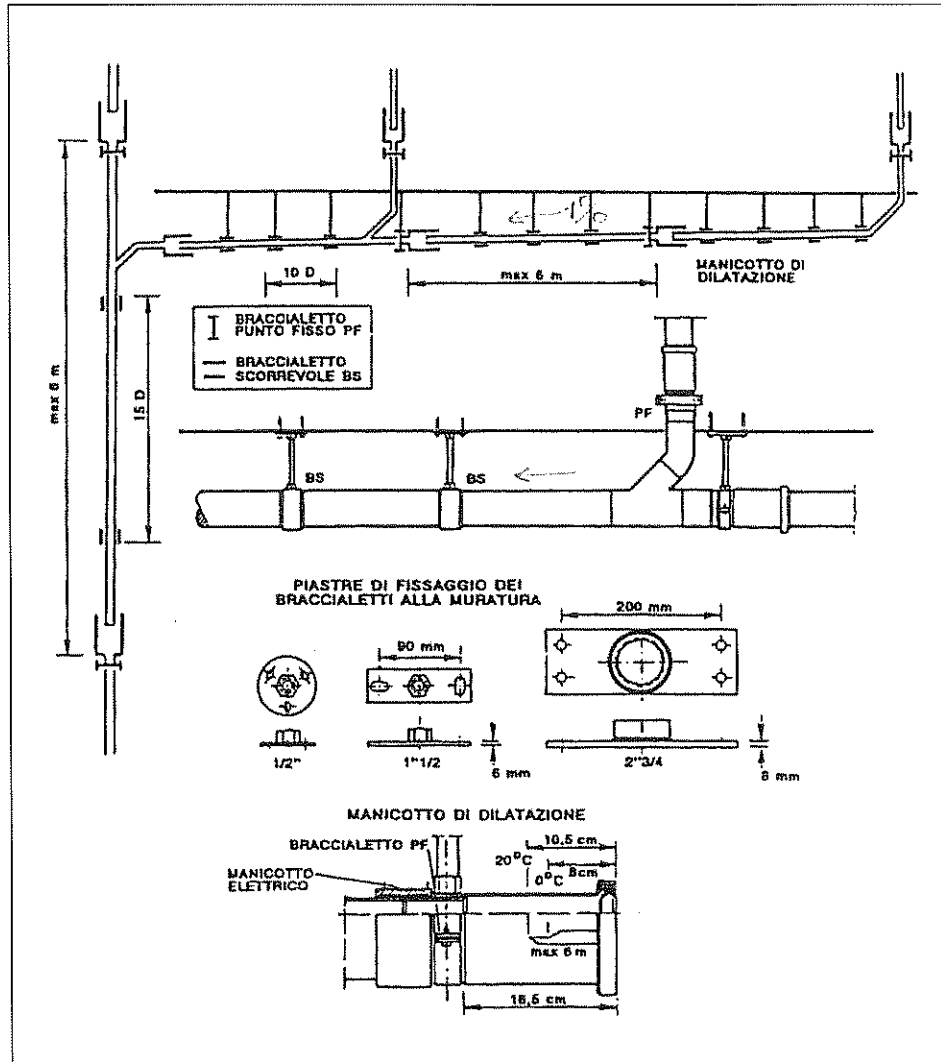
schema tipo di ancoraggio delle condotte di scarico alle travi ed alle pile dei viadotti.
